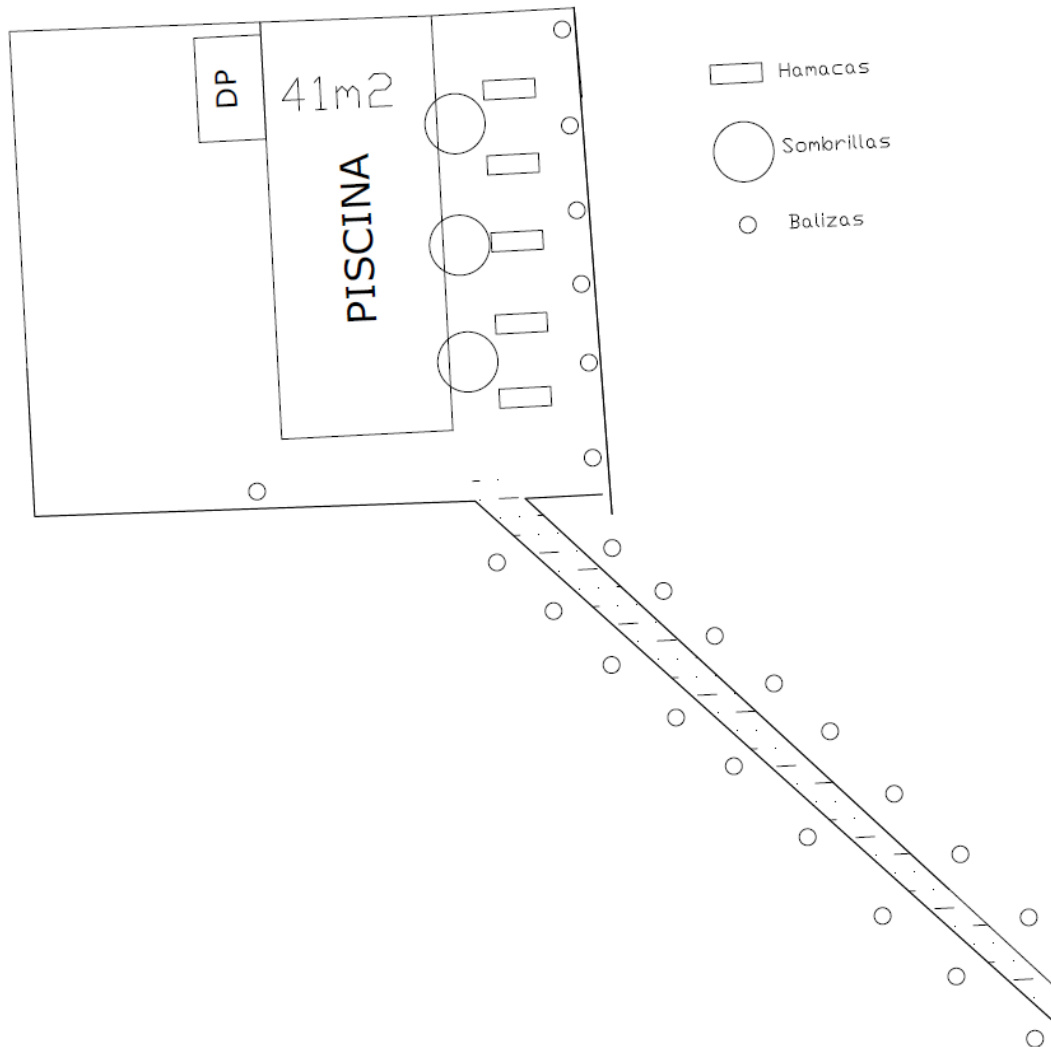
Plano de detalle piscina y camino. Fuente:propia.
